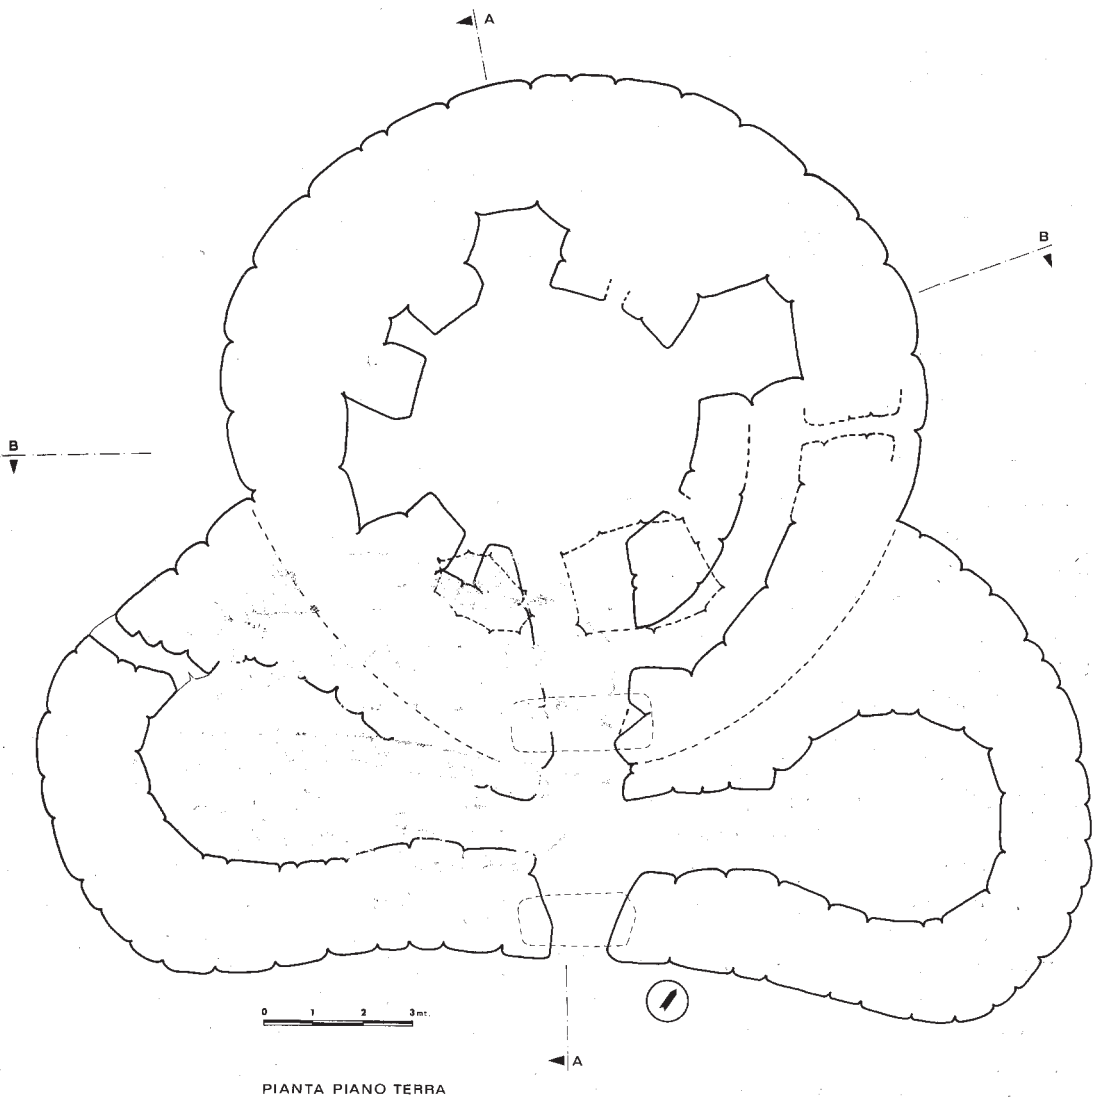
Bortigali, Nuraghe Orolo: planimetria del piano-terra.
